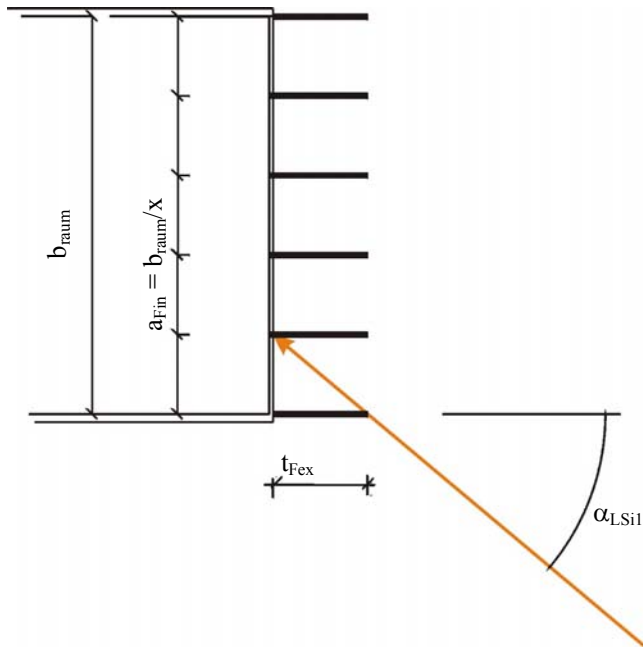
Grundrissausschnitt des Modellraums
